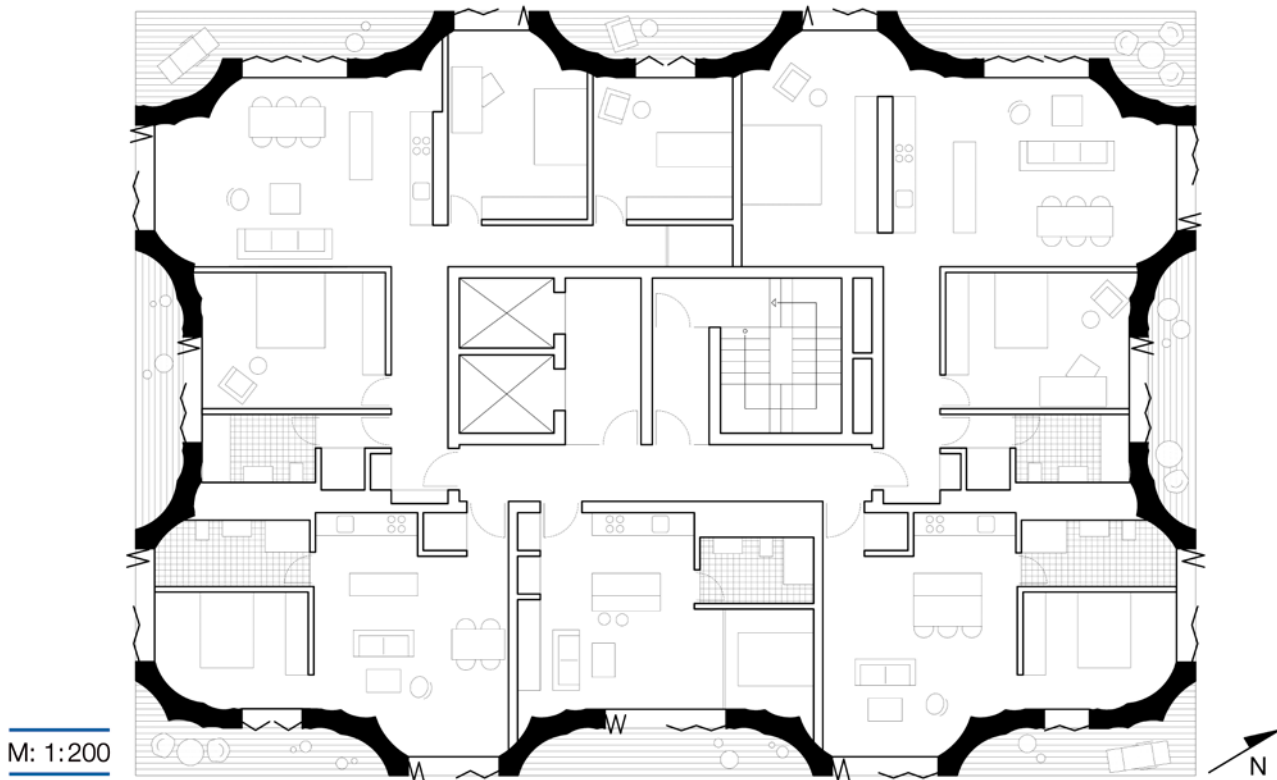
Typenentwurf »Punkthochhaus«, Grundriss Regelgeschoss
